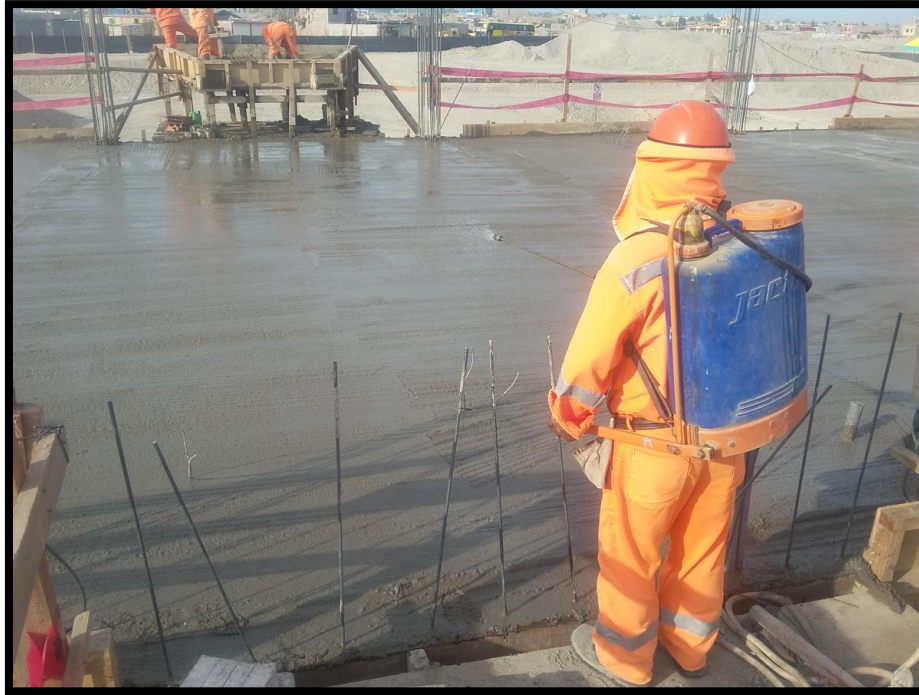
Se aprecia aplicación de aditivo curador tipo membrana en la losa aligerada.
